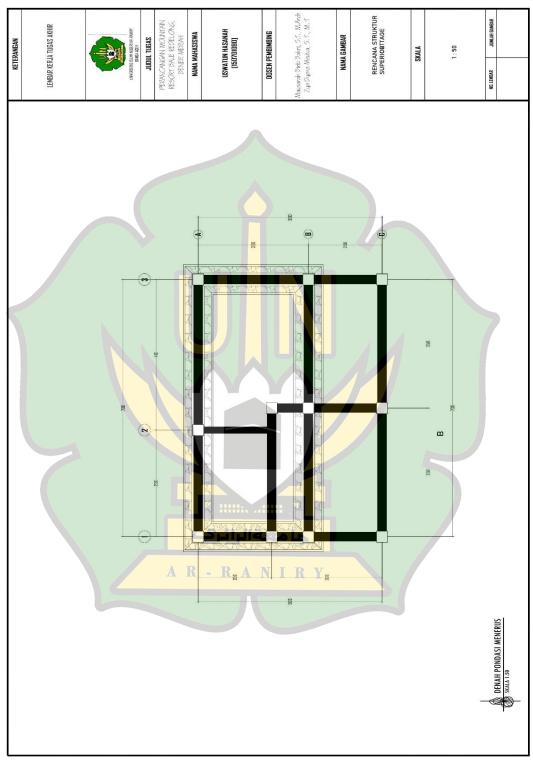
Rencana Pondasi Menerus *Suite Family* Sumber : Rancangan Pribadi
